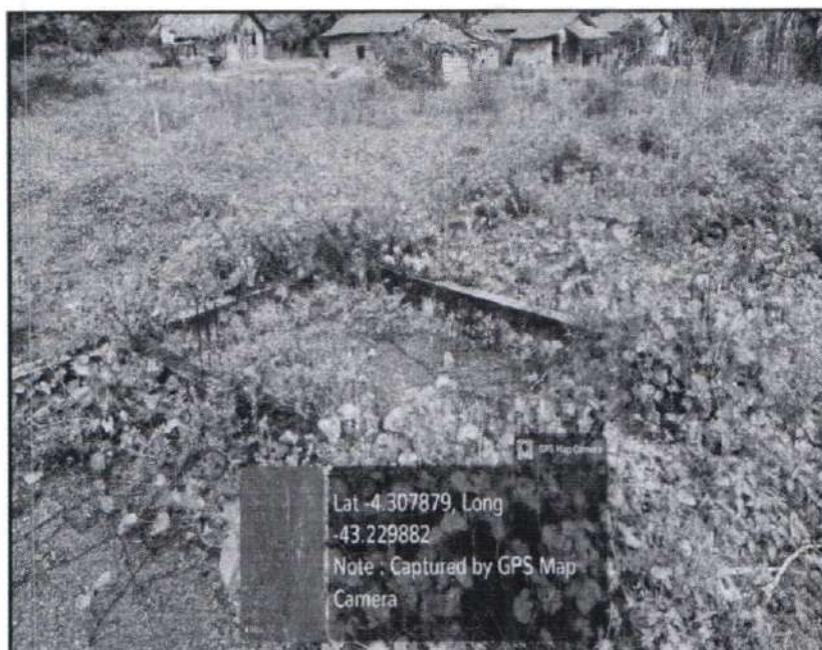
Vigas baldrame encontram-se expostas, sem o aterro previsto executado e sem o recebimento de impermeabilização. Fonte: elaboração própria
